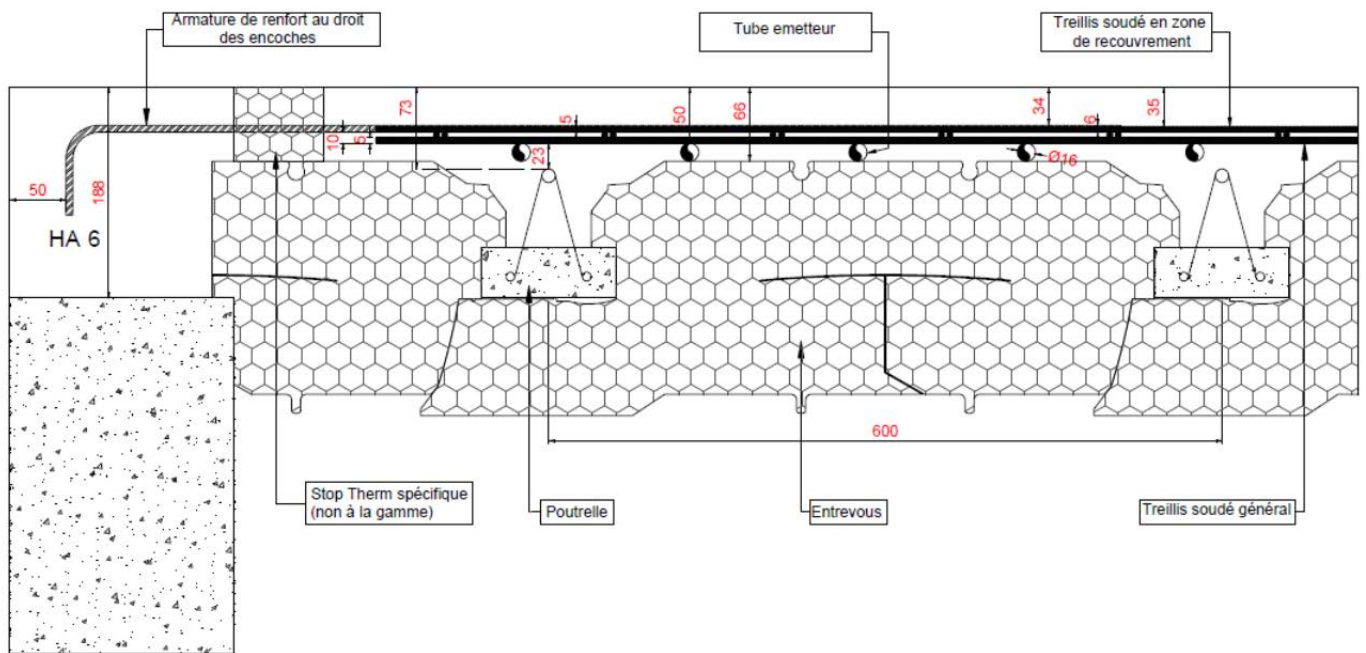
Coupe sur plancher avec tubes de 16mm et table de compression standard de 66mm
